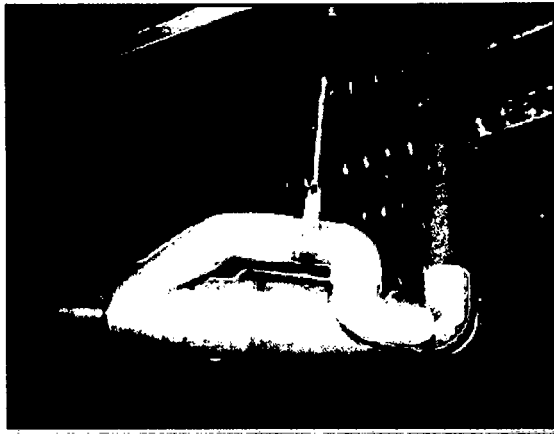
3: Ejemplo de colocación de tuberías de desagüe por debajo de la losa colaborante.
